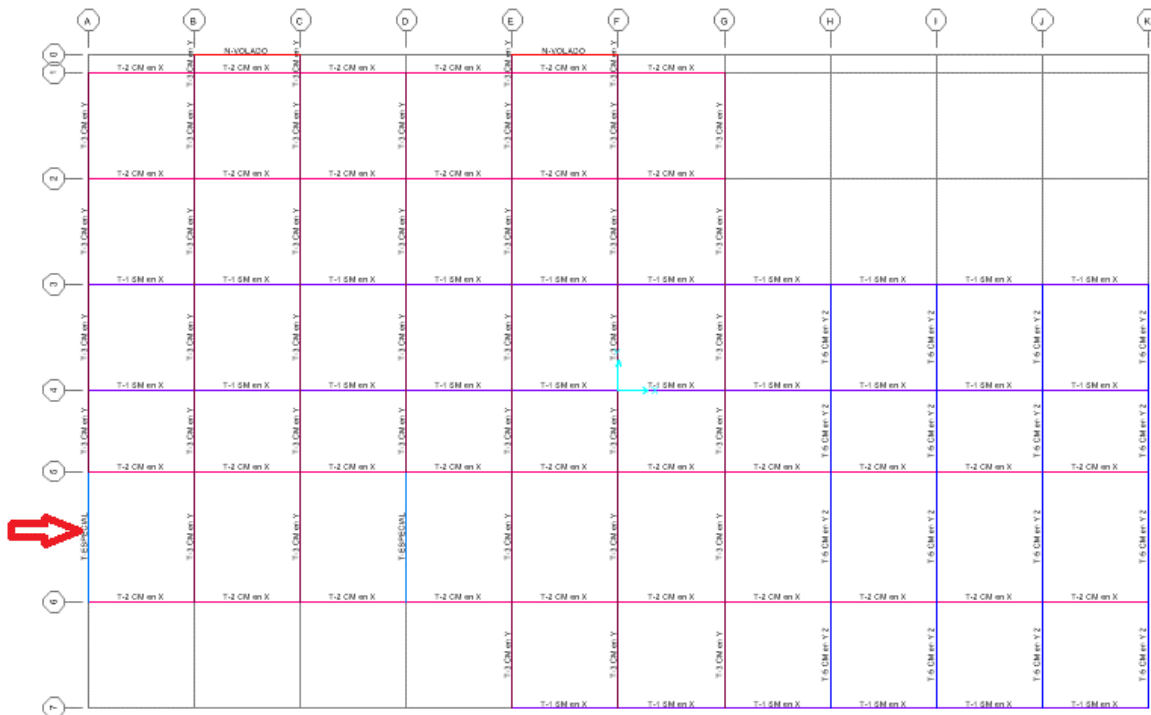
Ubicación de la trabe (TE) en SAP2000.
